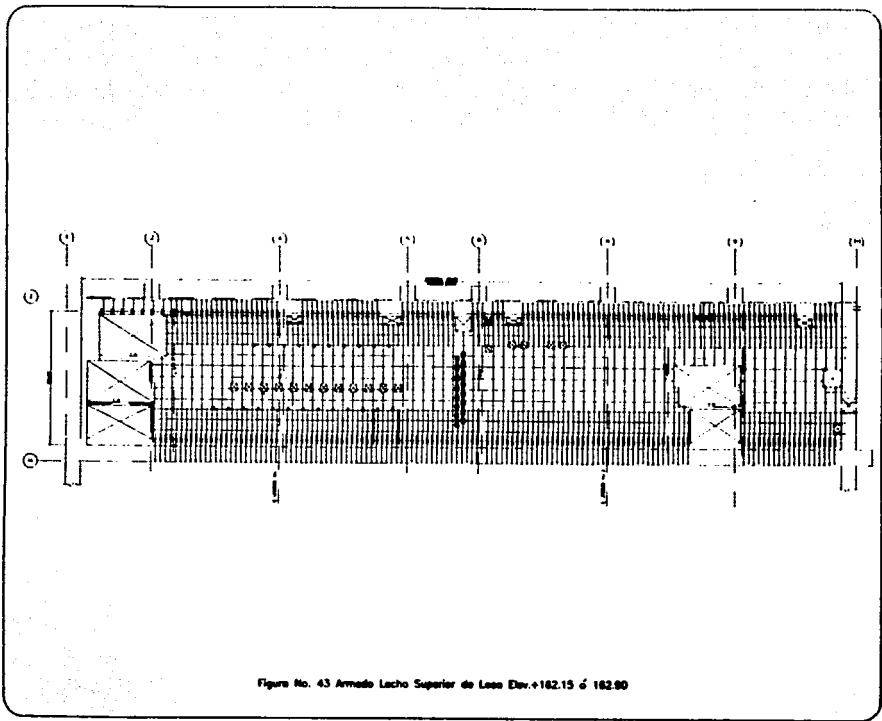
Armado Lado Superior de Lazo Div.+162.15 c 162.80
